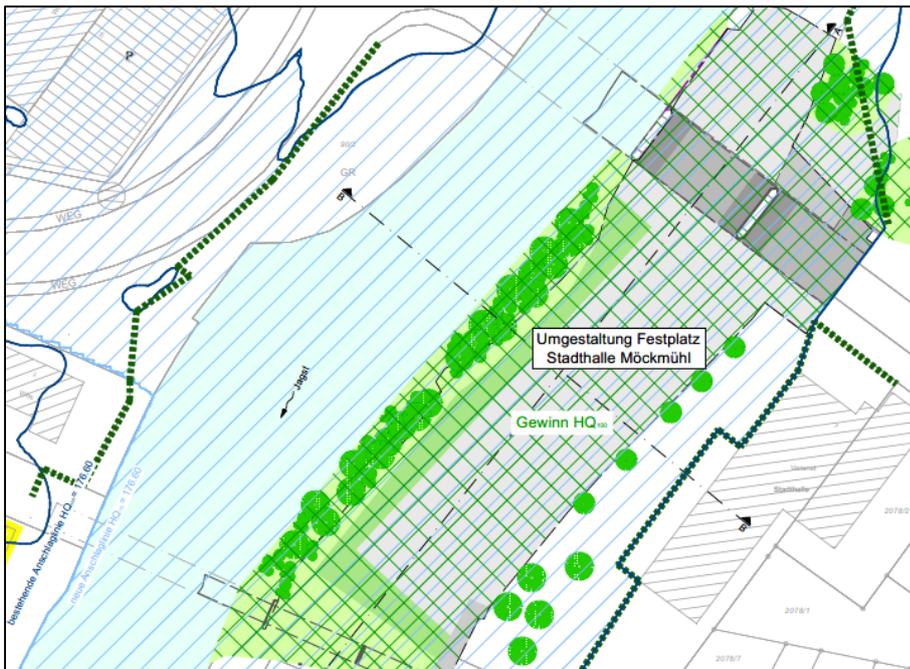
Lageplan Umgestaltung Festplatz mit Gewinnfläche
